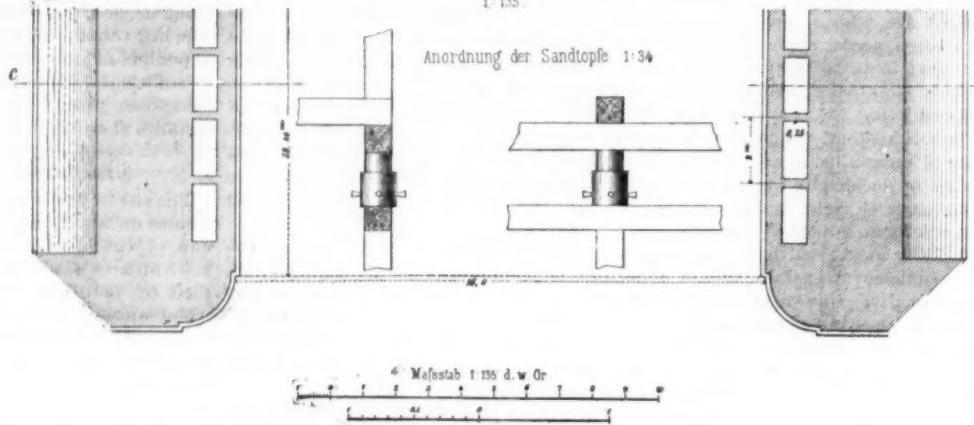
Grundriss nach a b (in Fig. 2)
